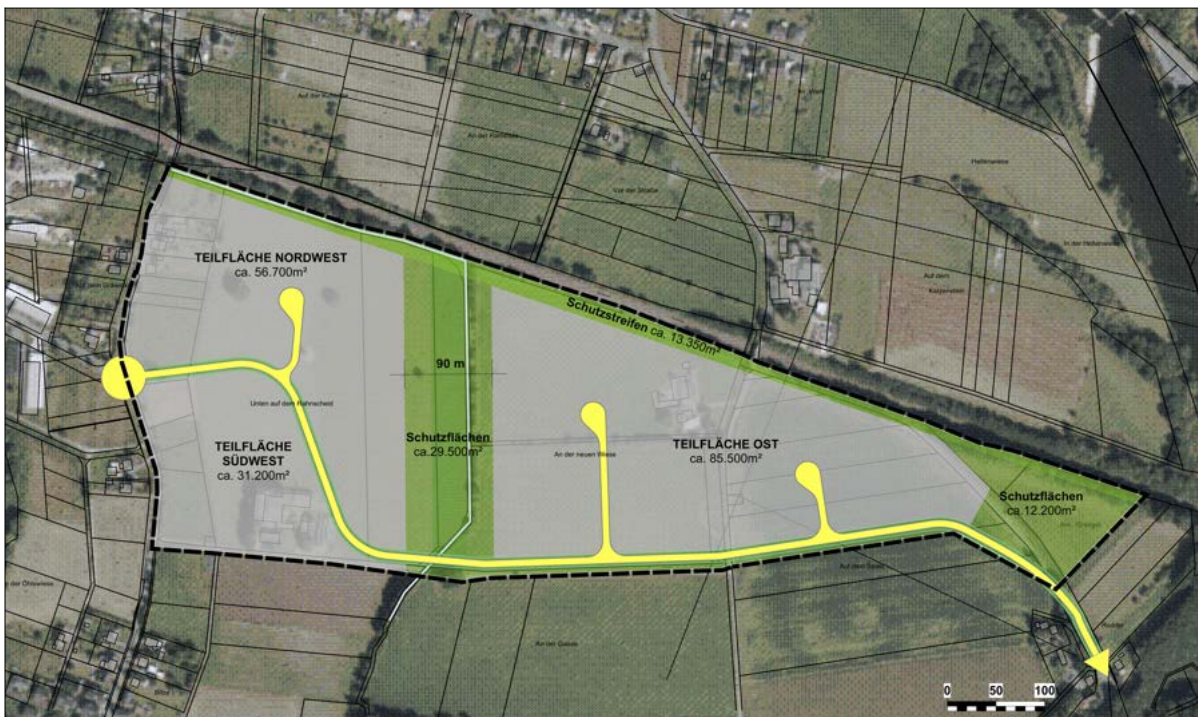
Informelle Planung - Erschließungsvariante C.1
